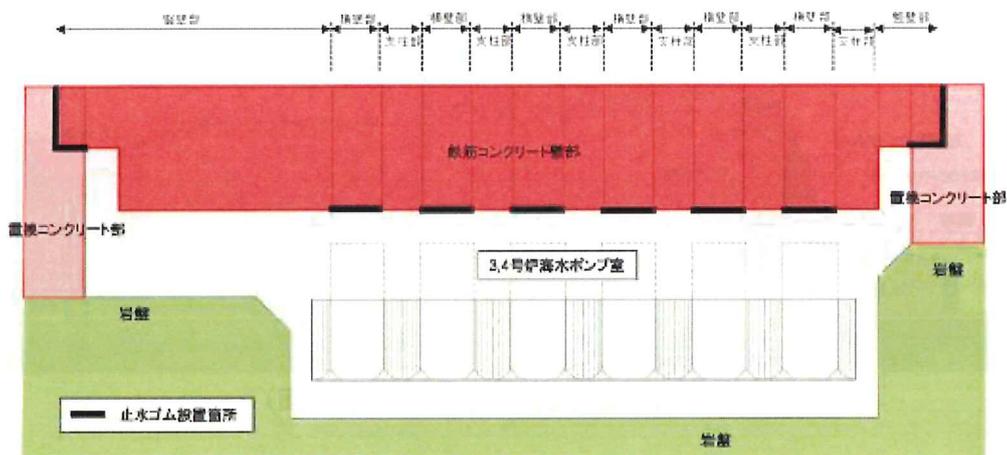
止水ゴム設置概要正面図 (C-C' 断面)
